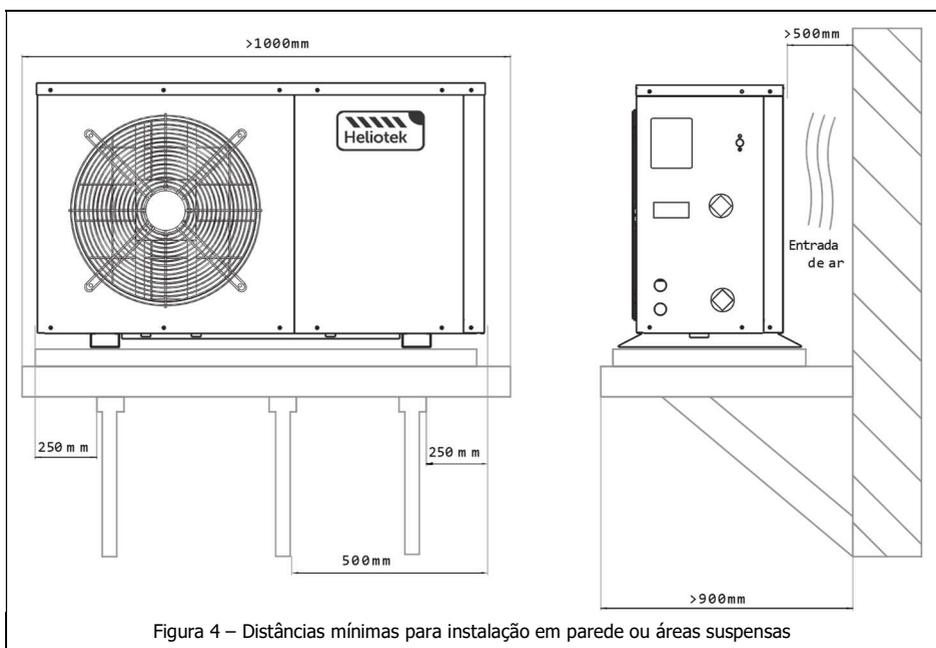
Distâncias mínimas para instalação em parede ou áreas suspensas
